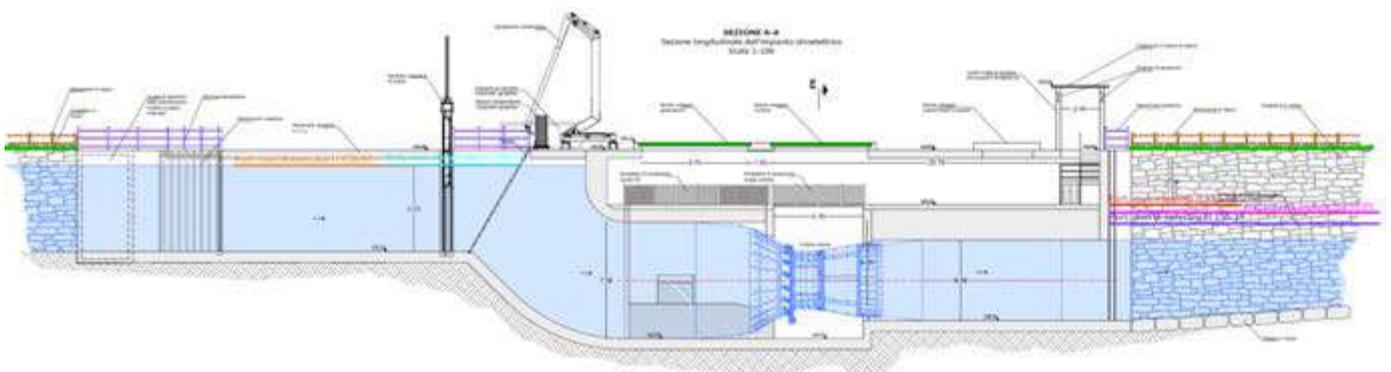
Sezione longitudinale turbina Kaplan "PIT"
